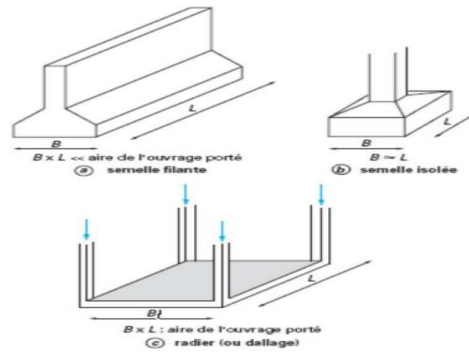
Fondation superficielle (Semelle filante(a), Semelle isolée(b), Radier général(c))
